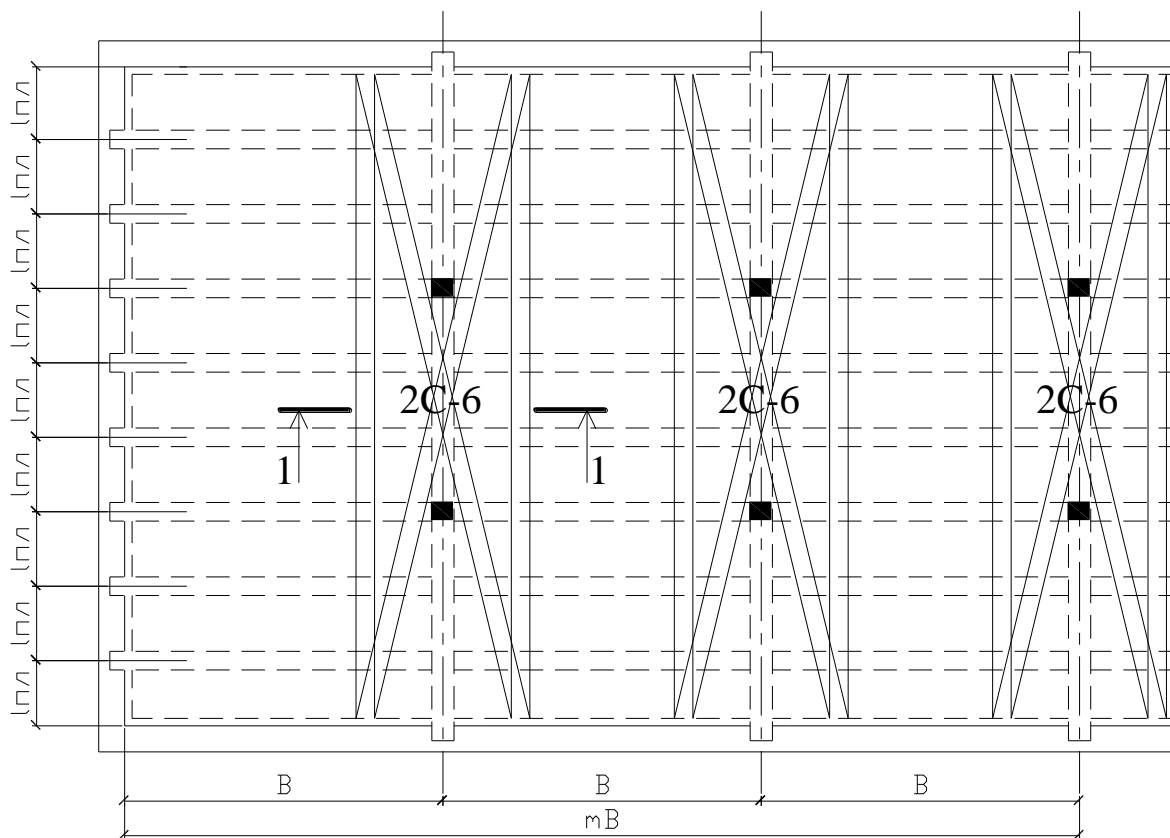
Непрерывное армирование балочной плиты рулонными сетками
